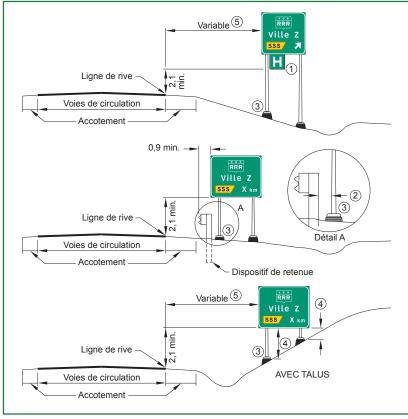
Extrait du DN V-5-052 «Installation de panneaux en bordure de la chaussée »
